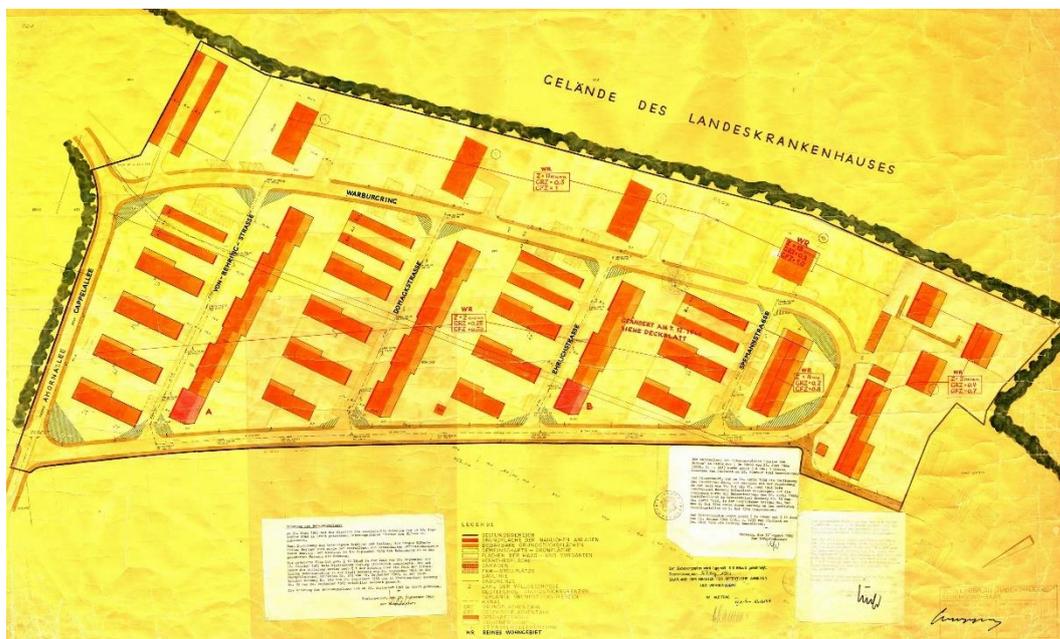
Bebauungsplan „Hinter den Birken“ aus den 60er Jahren (Quelle: Stadt Homburg)
